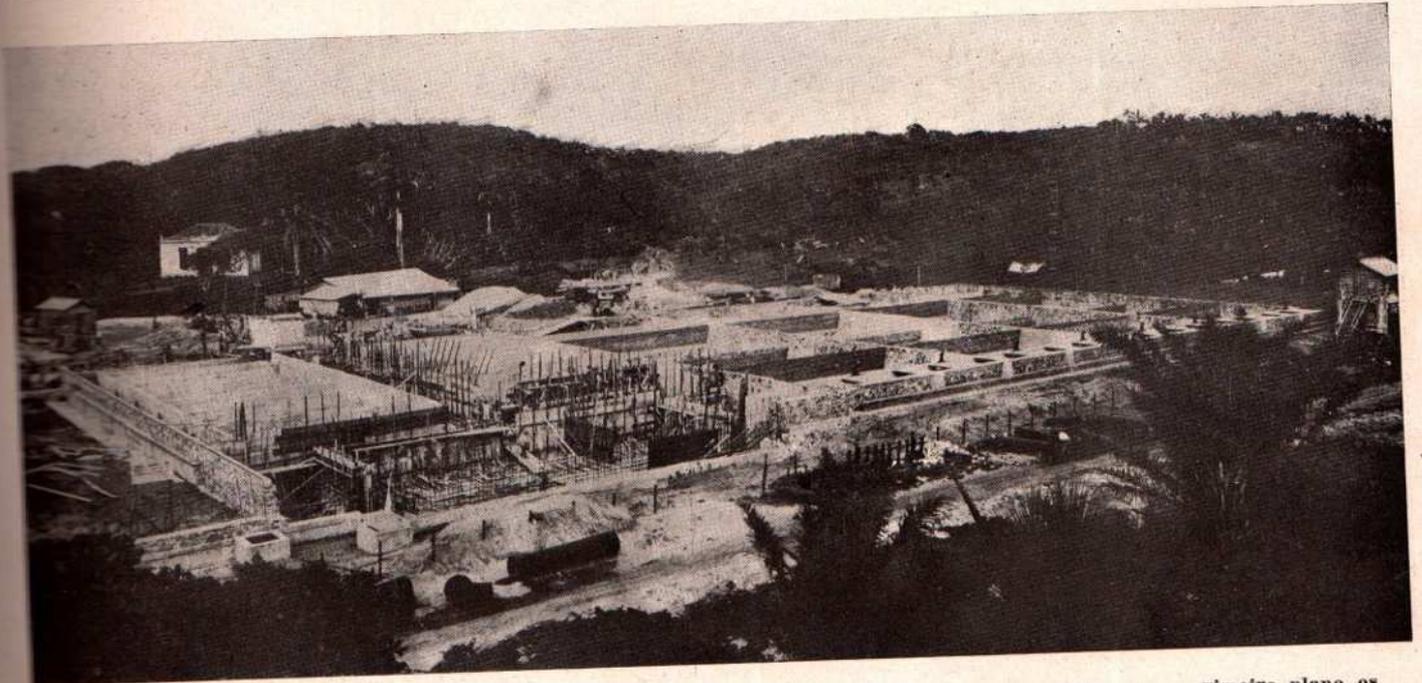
Bolandeira, uma das mais importantes installações de tratamento d'agua do Brasil. Vee-se no primeiro plano os filtros em construcção e no segundo plano os decantadores. Em outro edificio a usina electrica.
